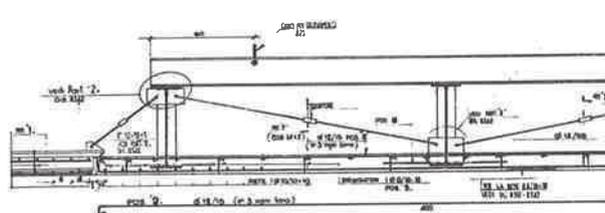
Particolare dei tiranti di sostegno delle predalles secondarie.
